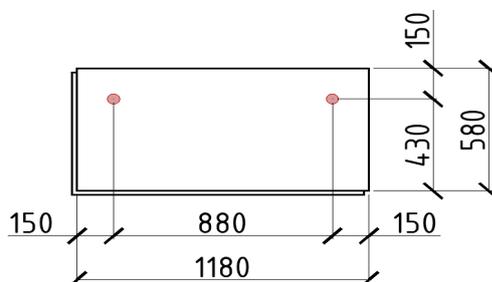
Схема крепления теплоизоляционных плит из экструзионного пенополистирола
